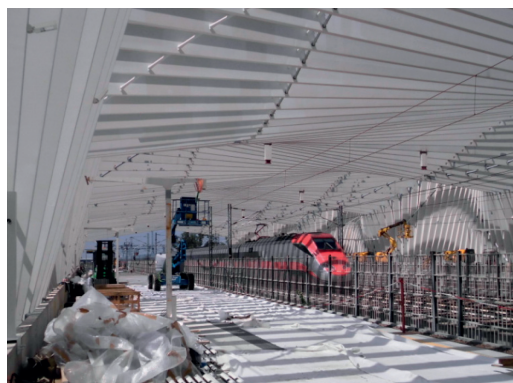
Piano banchina durante i lavori di posa della pavimentazione in pietra di luserna.
